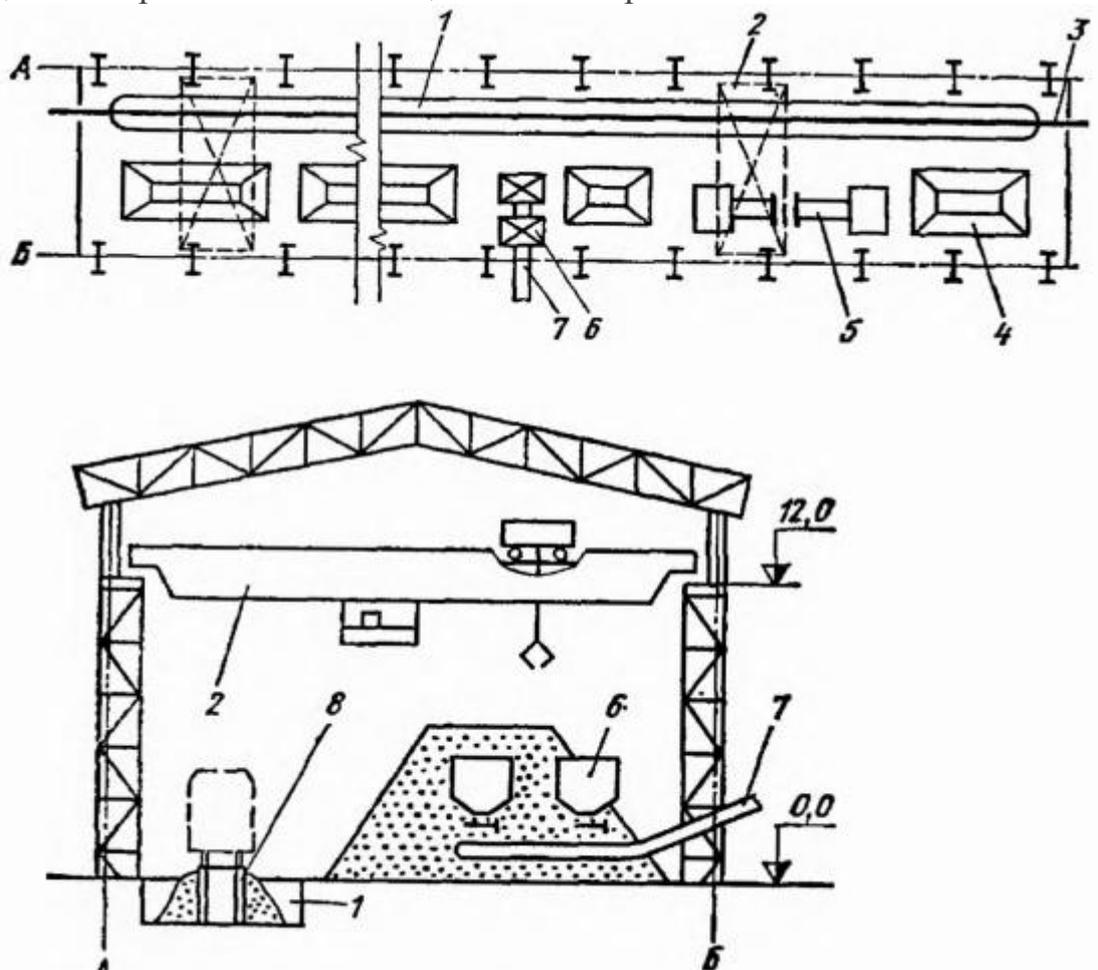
План и поперечный разрез нижнего шихтового отделения с хранением материала в штабелях
